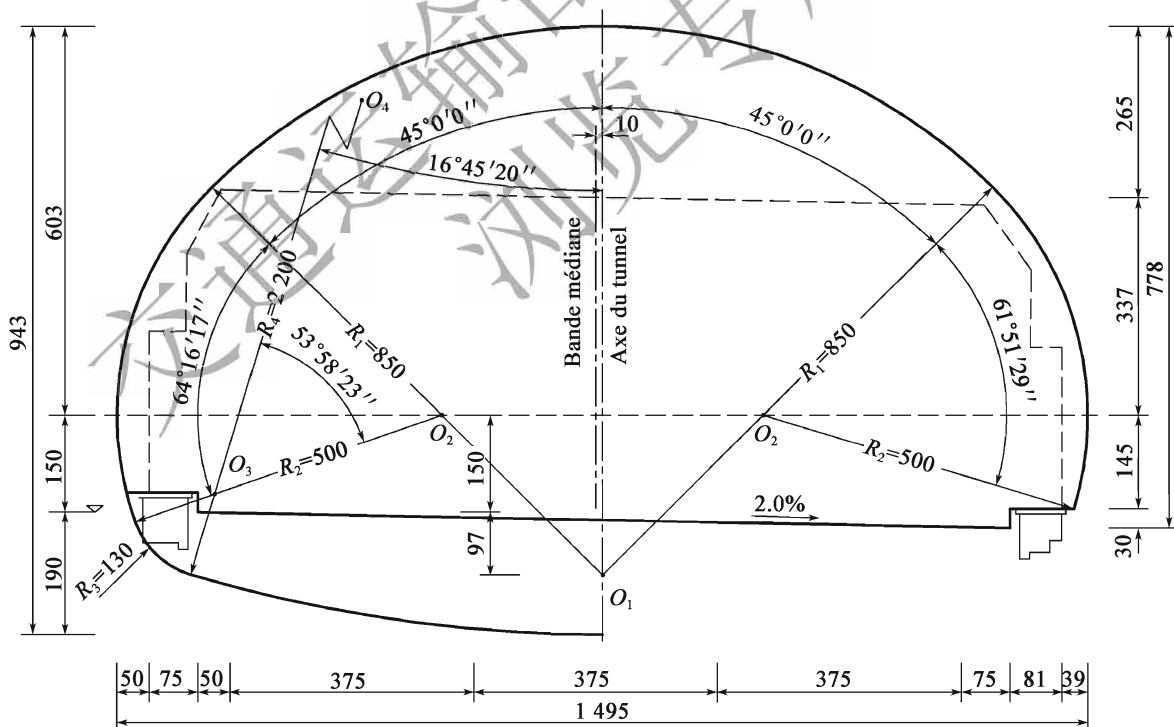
Gabarit du tunnel autoroutier et du tunnel routier de première classe à trois voies(80km/h) (unité:cm)
